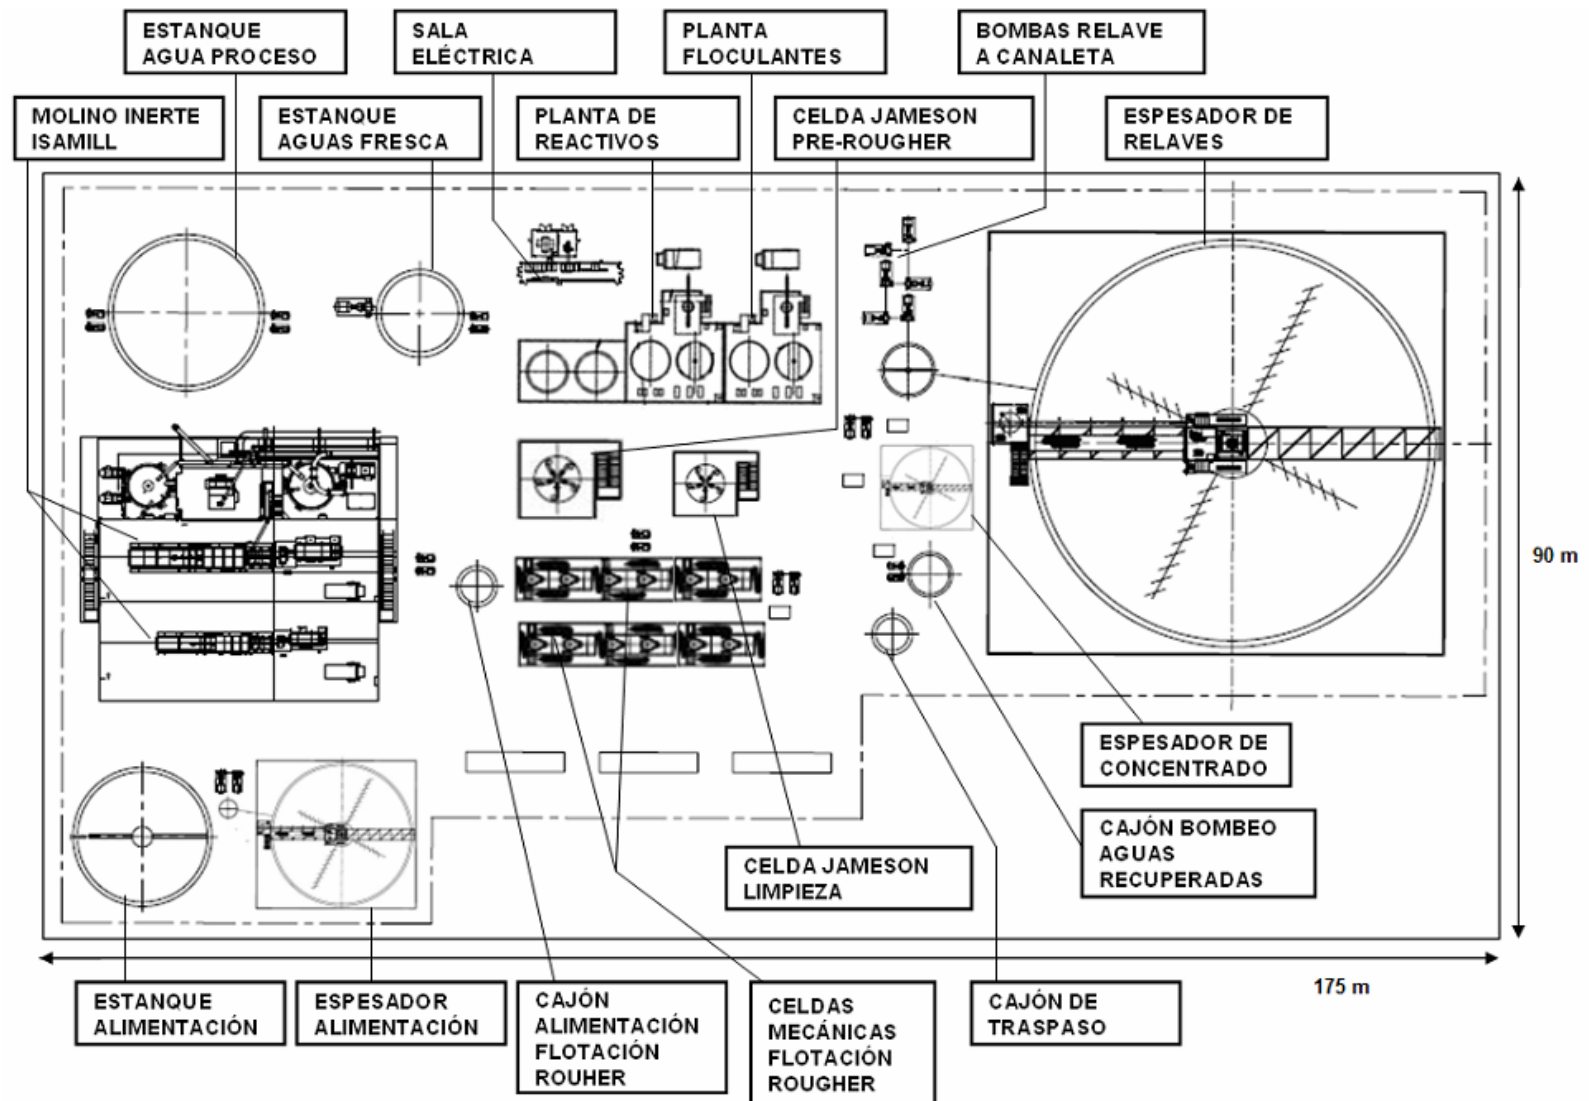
Layout de la Planta de Retratamiento Piuquenes
